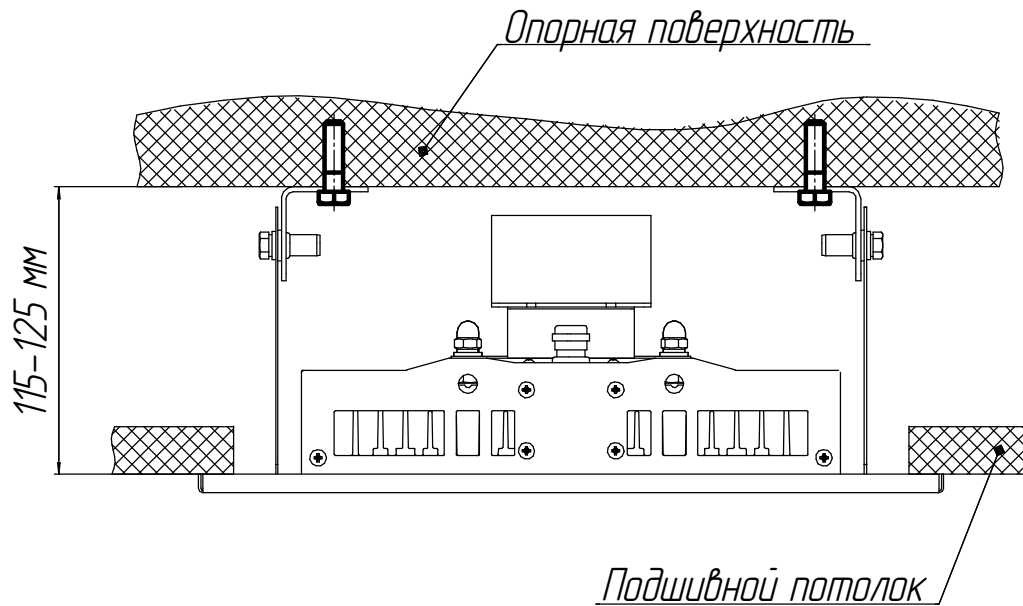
Установка светильника с креплением к опорной поверхности
